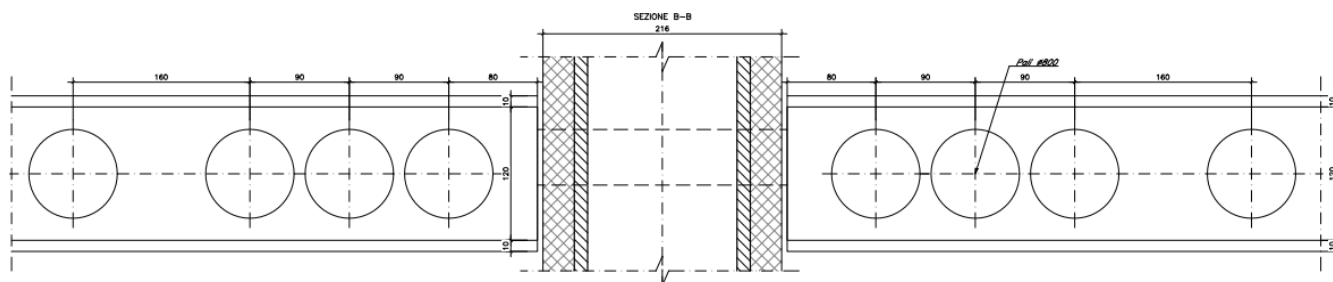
Pianta fondazione scavalco di recinzione con barriera antirumore
